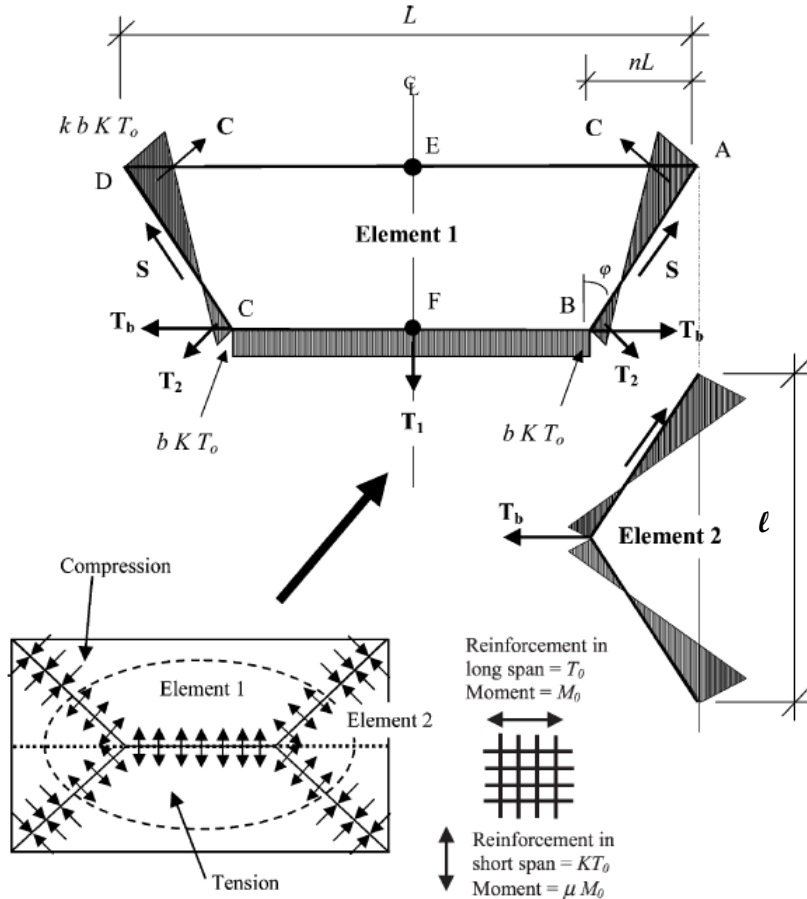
Définition du ferrailage orthotrope et efforts plans sur les lignes de rupture d'une dalle rectangulaire [BAI 04a]
